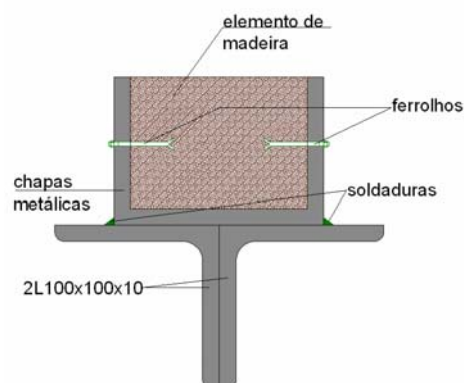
Exemplo de ligação possível entre as diagonais de reforço e os elementos de madeira do pavimento
